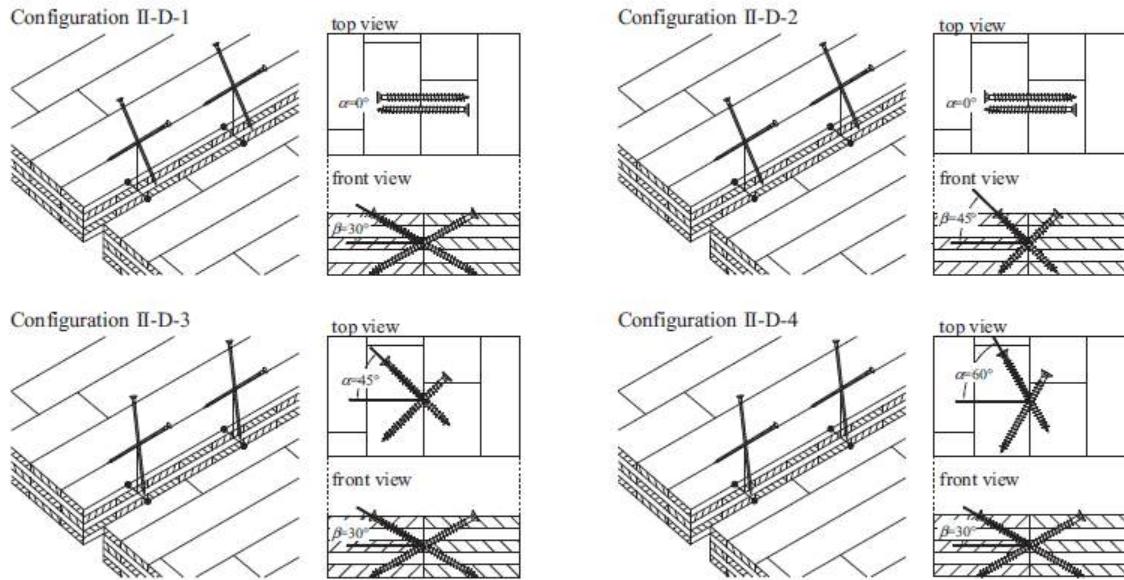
Connexion entre panneaux pour les planchers et diaphragmes mixtes acier-CLT [54]
